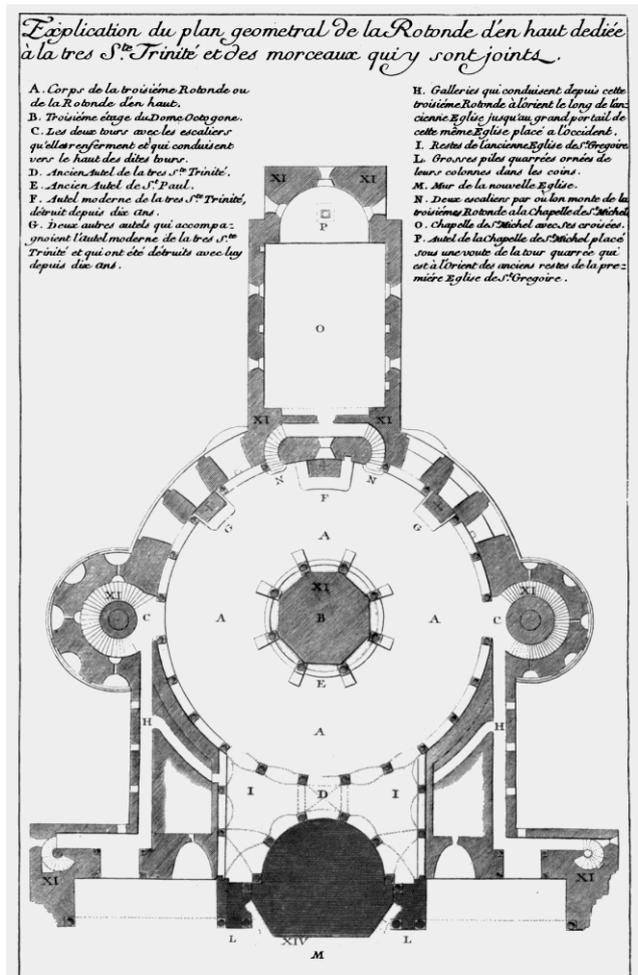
Grundriss des Rotundenobergeschosses (Dom PLANCHER 1739)
